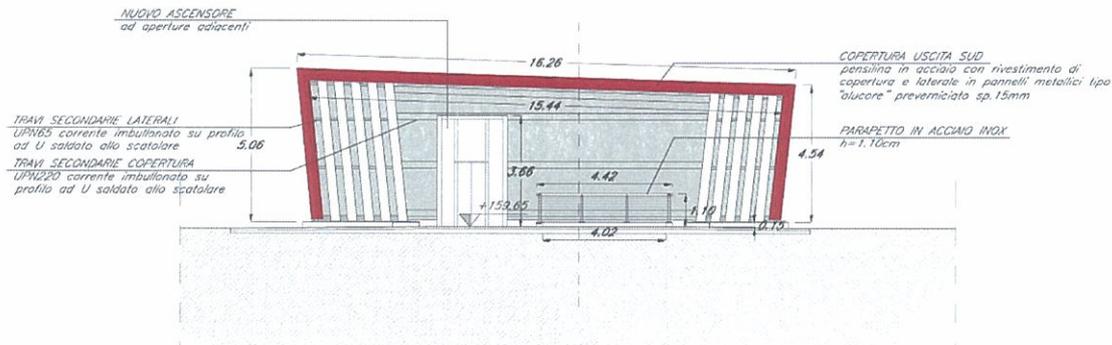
shelter copertura scale ingresso sud fermata di Vanzago
